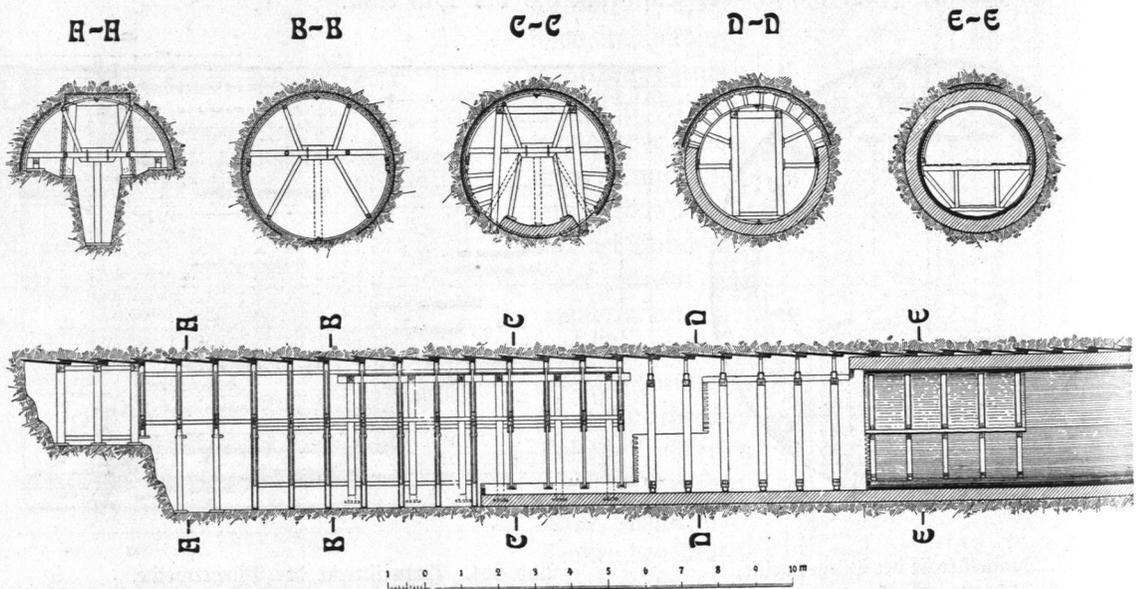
bis 660. Stammfisstrecke Hafenstrasse, Vortriebsweise der Tunnelstrecke.
